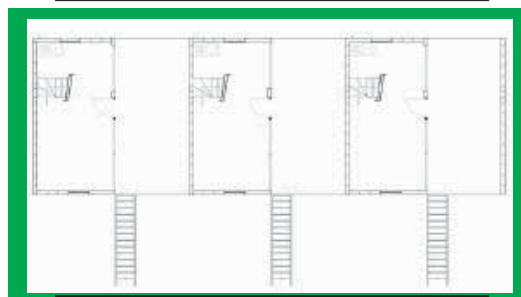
PLANTA 2 (DEPARTAMENTO) SIN AMPLIACIONES.
